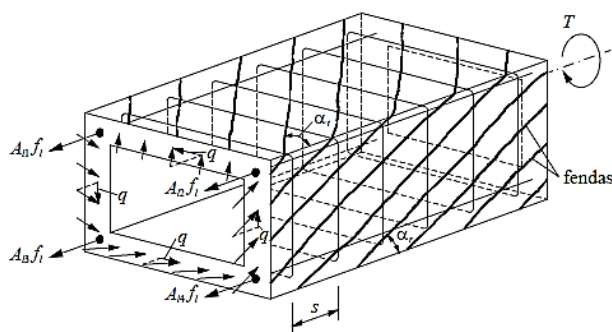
Modelo VATM para uma viga de secção retangular vazada sujeita à torção [56].
